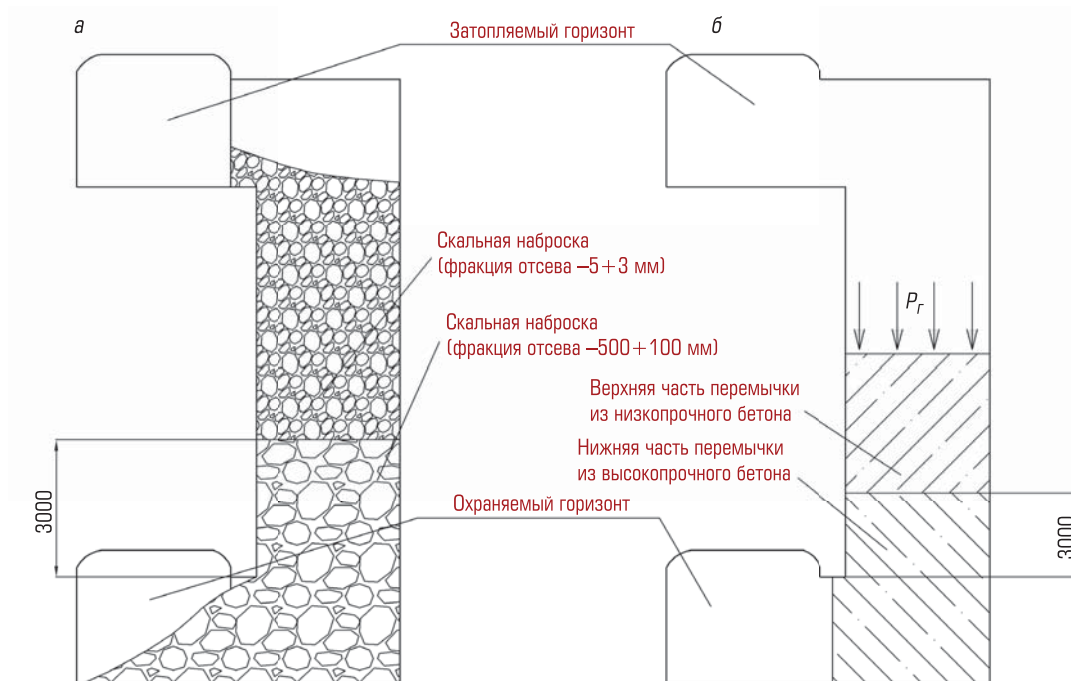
Устройство пульпоизолирующих перемычек в вертикальных выработках из скальных пород (а) и бетонных (б)
